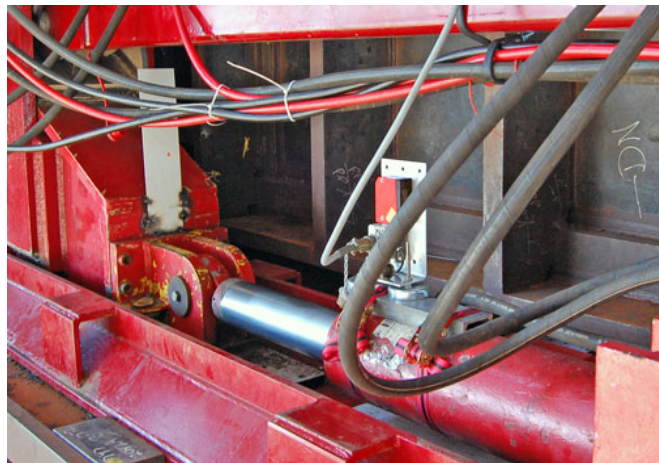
Hydraulische Elemente verschieben die Brückenteile (Quelle: Syrinx Industrial Electronics, www.syrinx.nl)
